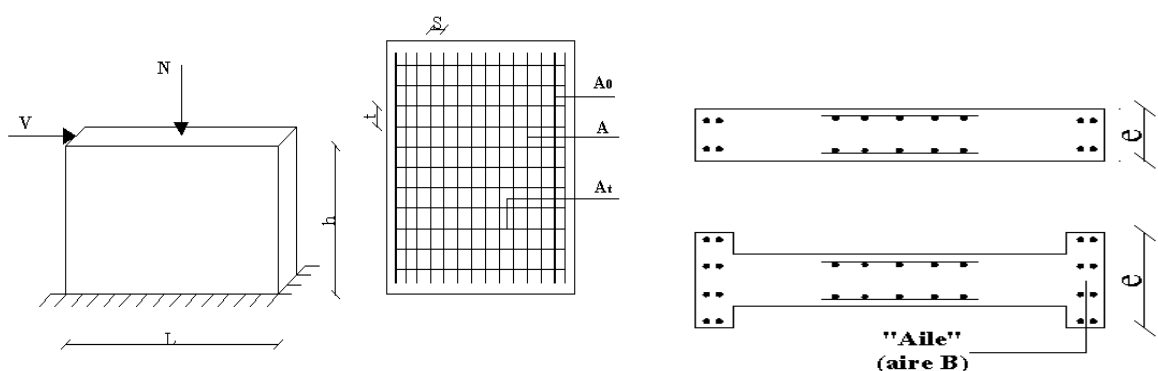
Schéma d'un voile plein et disposition du ferrailage.
